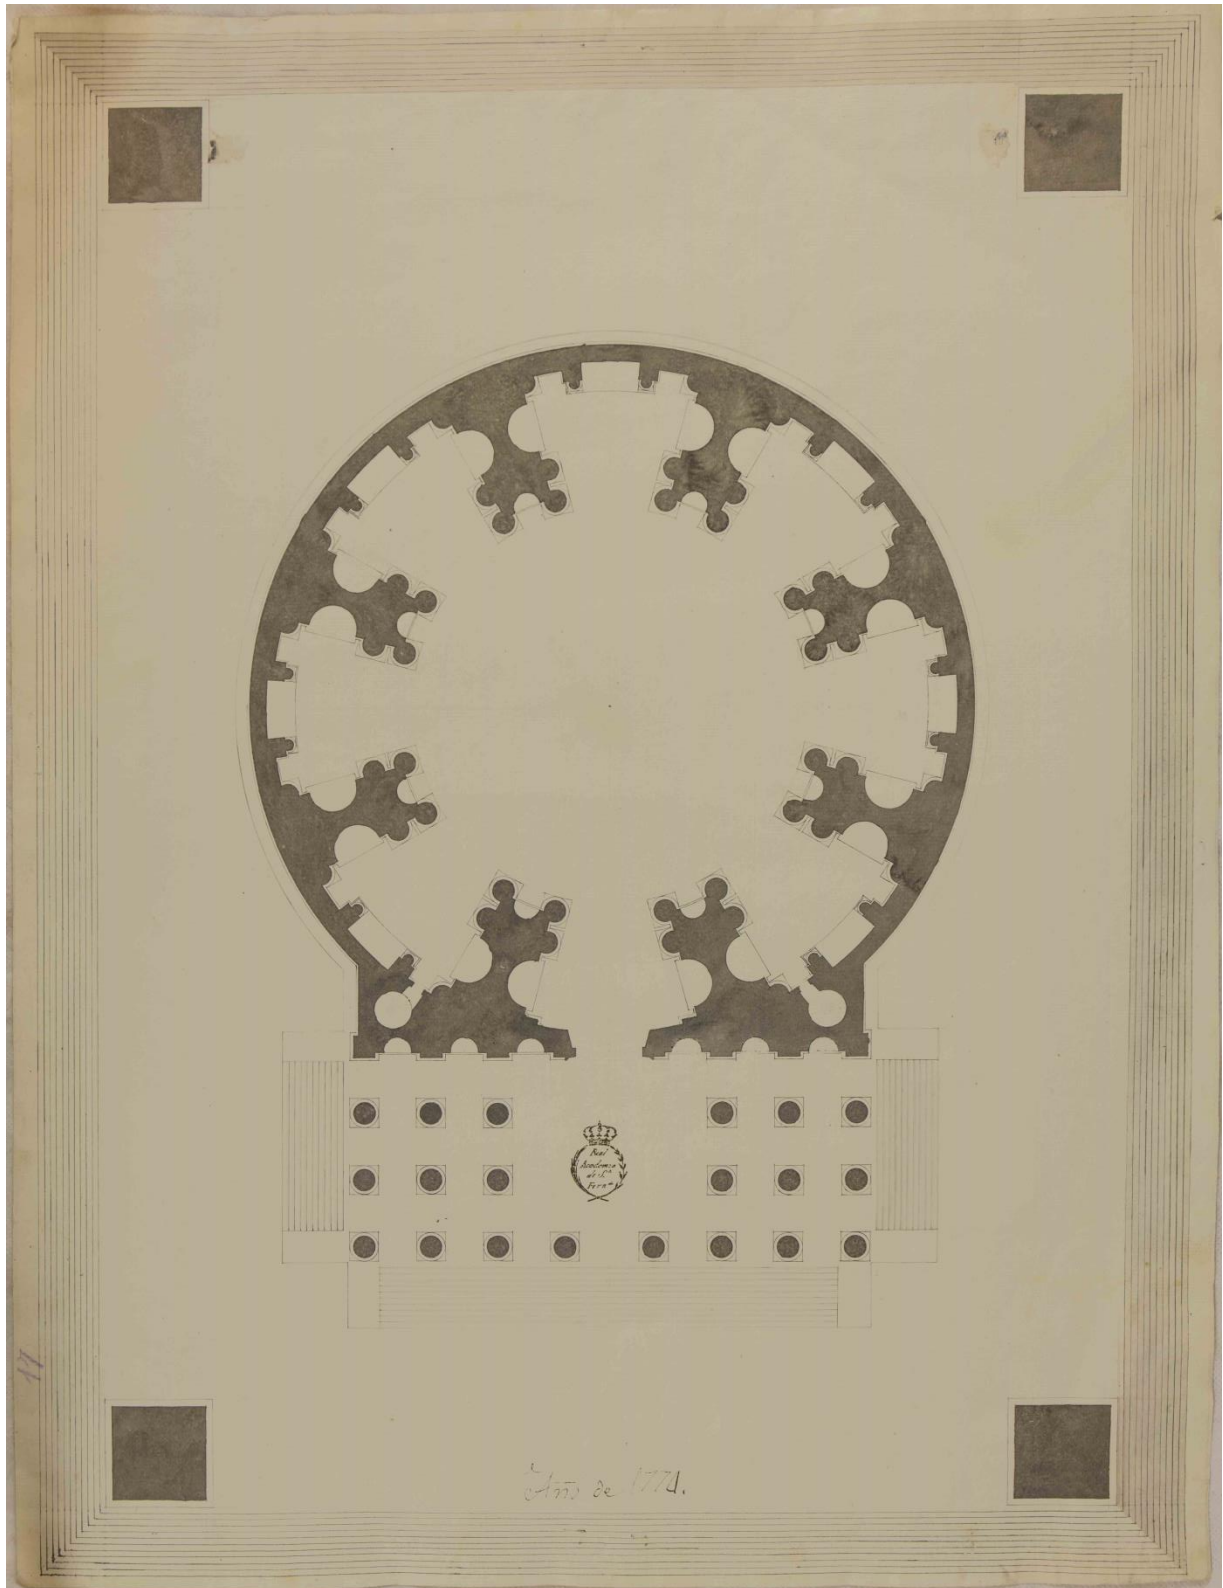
Dibujo A-4817: Planta, Archivo R.A.B.A.S.F.
